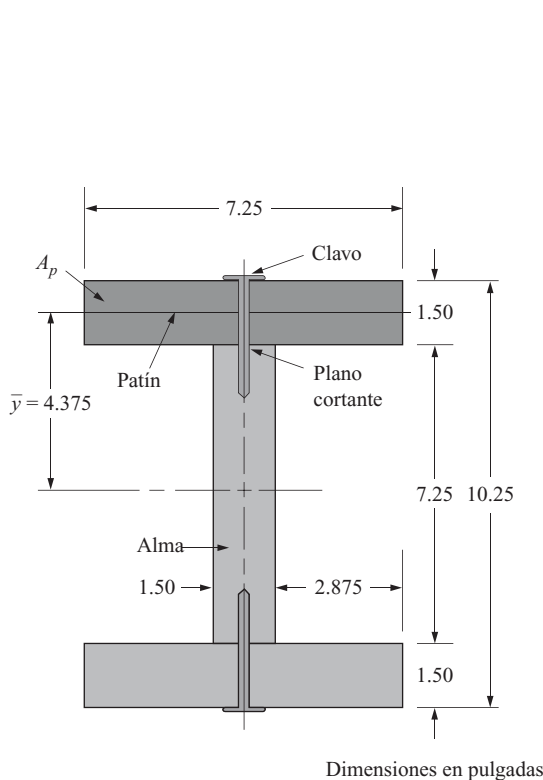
Perfil de viga del problema de ejemplo 8-12.
